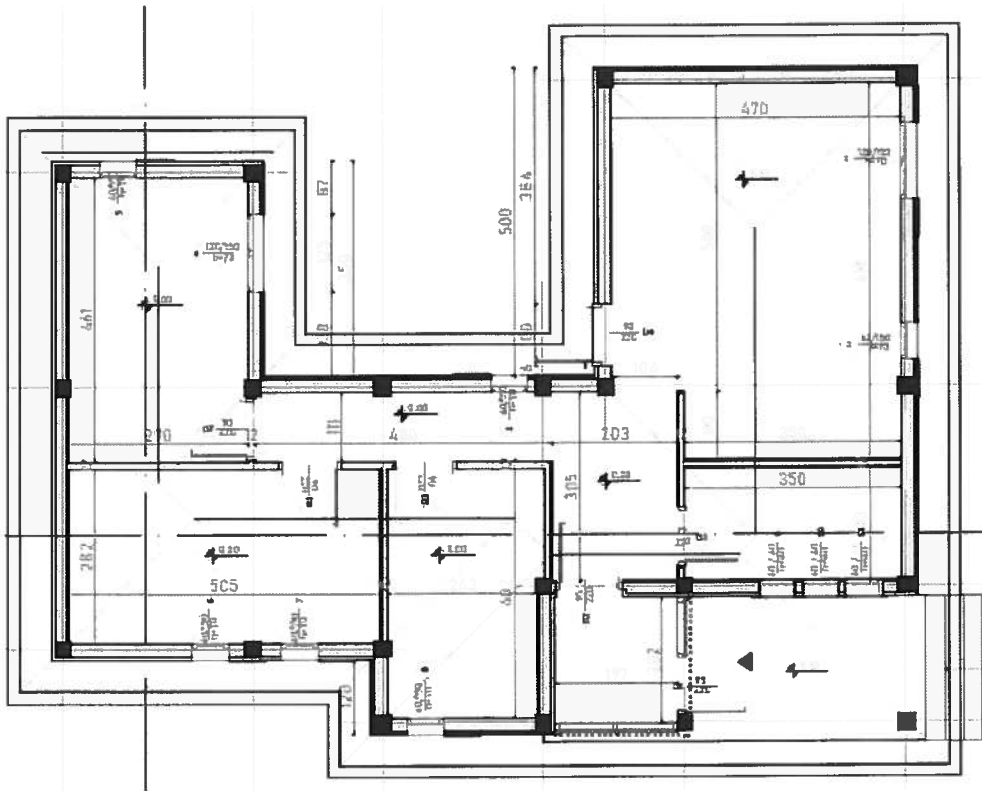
Planimetria e ndërtesave tip 1+1
